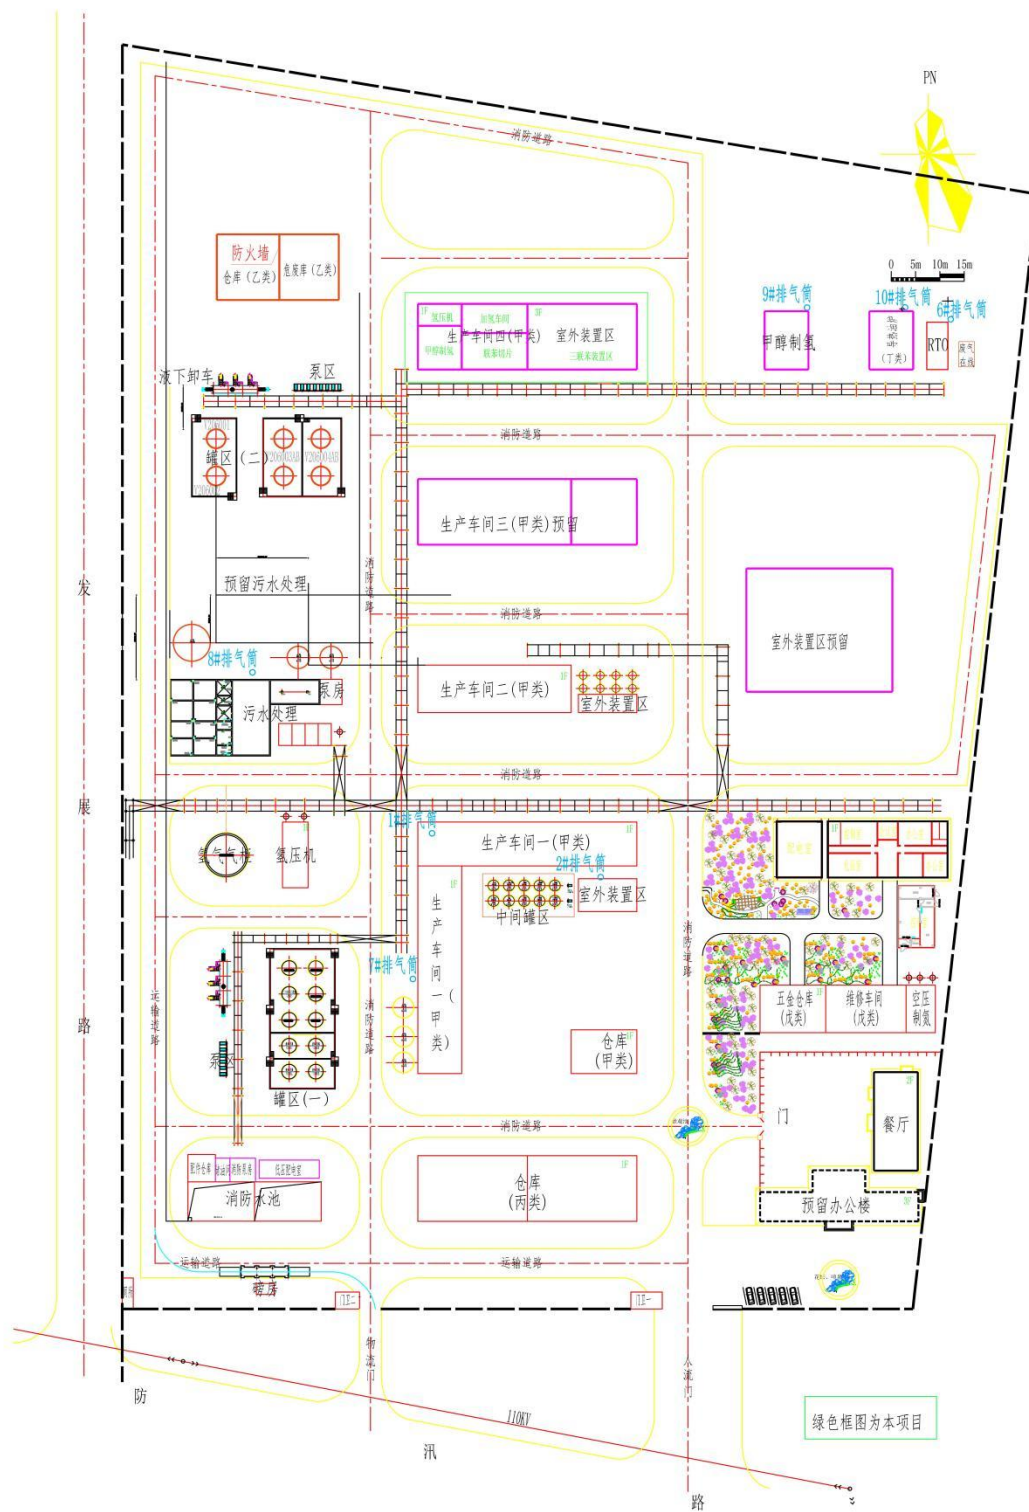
济宁市金泰利华化工科技有限公司厂区总平面布置图
